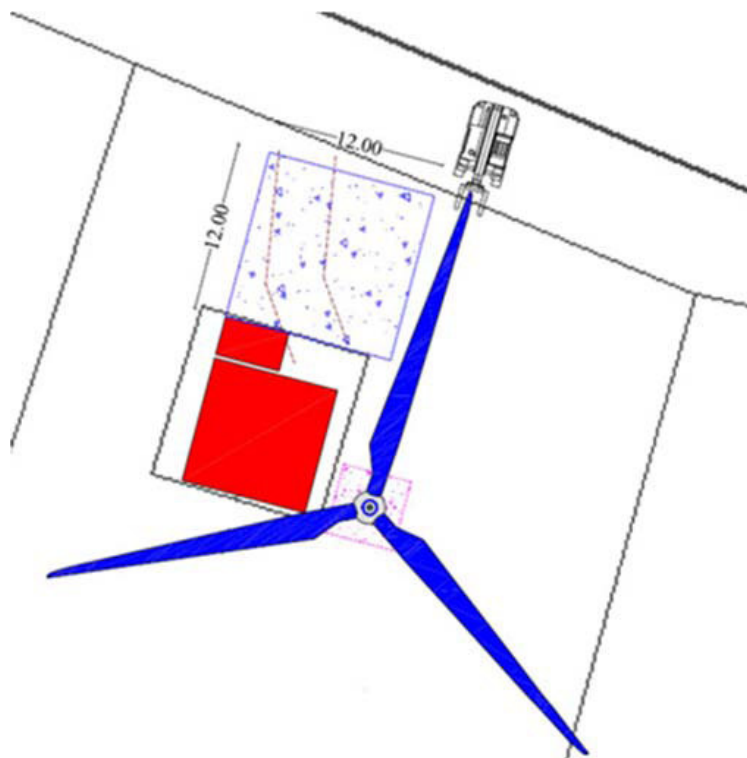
Schema tipico piazzola di smontaggio: i aree in rosso mostrano la fondazione dell'aerogeneratore (quadrato grande) e la fondazione della cabina (rettangolo piccolo).
